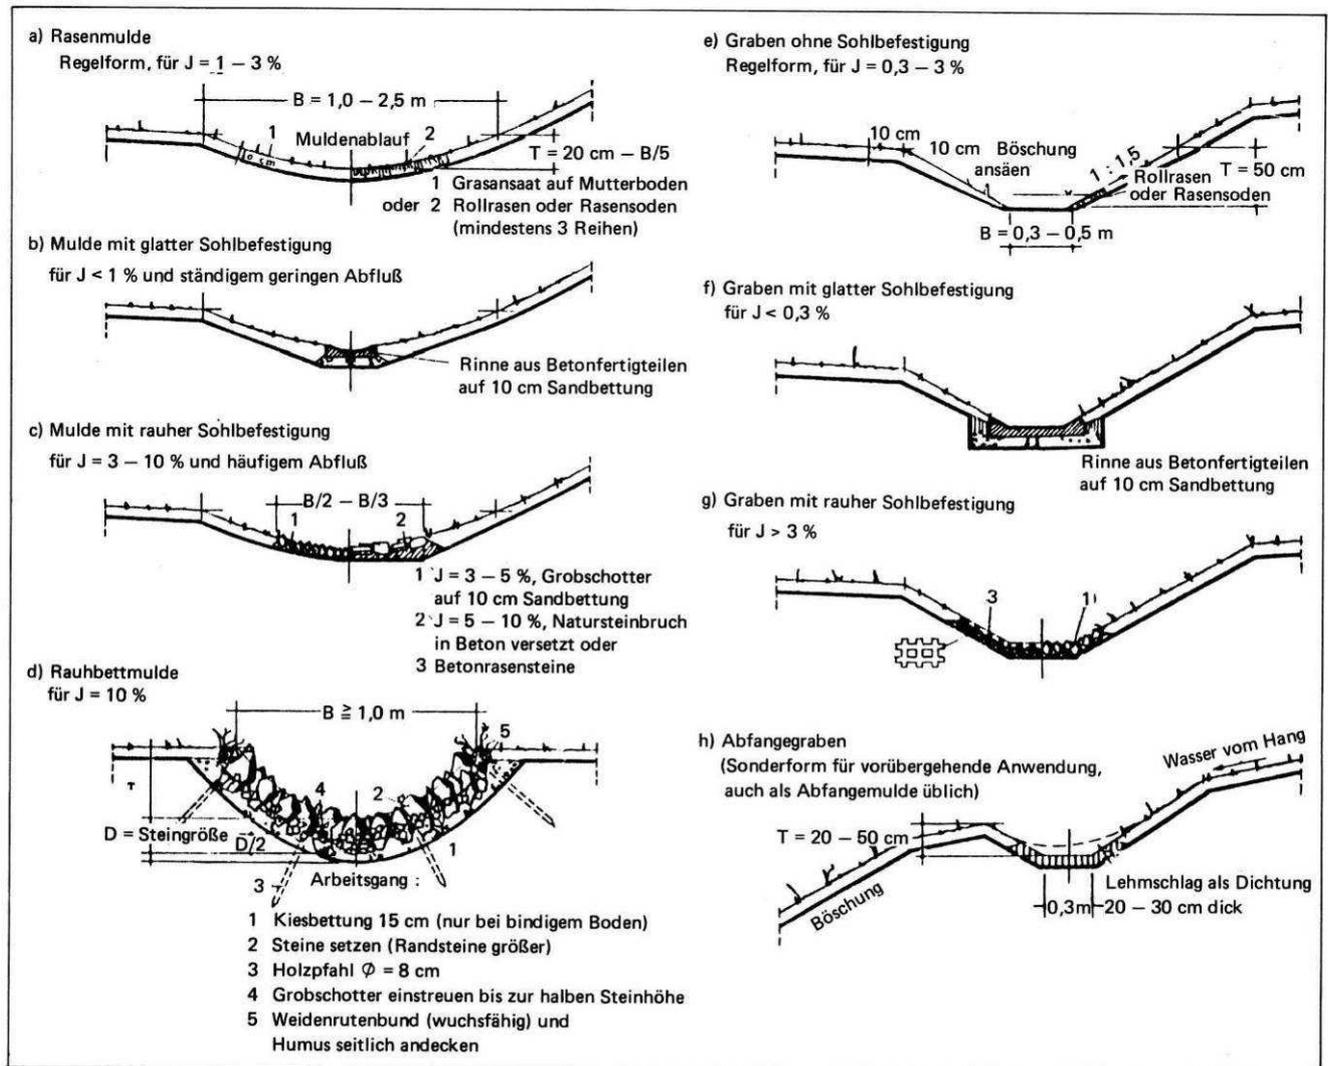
Différentes techniques de collecte des eaux de pluie avec infiltration dans la nappe.
